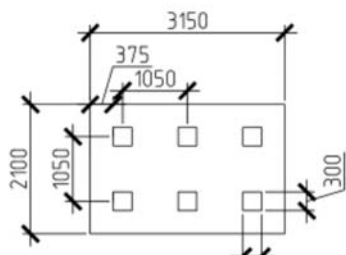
Типоразмеры свайного куста, вид сверху при типовом конструктивном решении, состоящем из шести свай.
